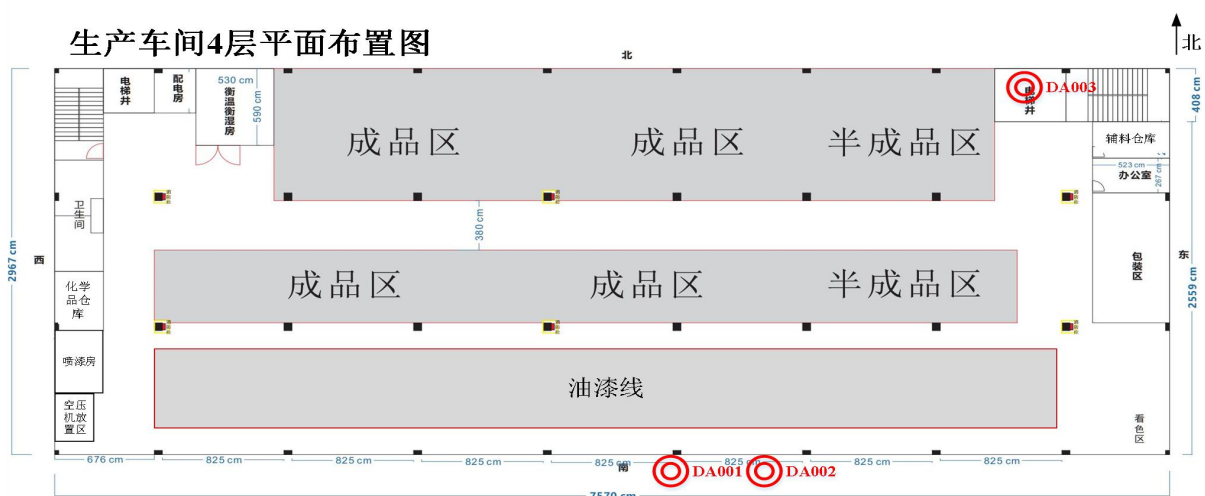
建设项目环评审批生产车间 4 层平面布置图
